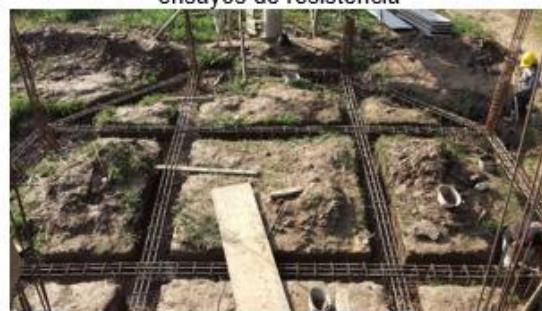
Instalación refuerzo viga de cimentación mirador N°2
